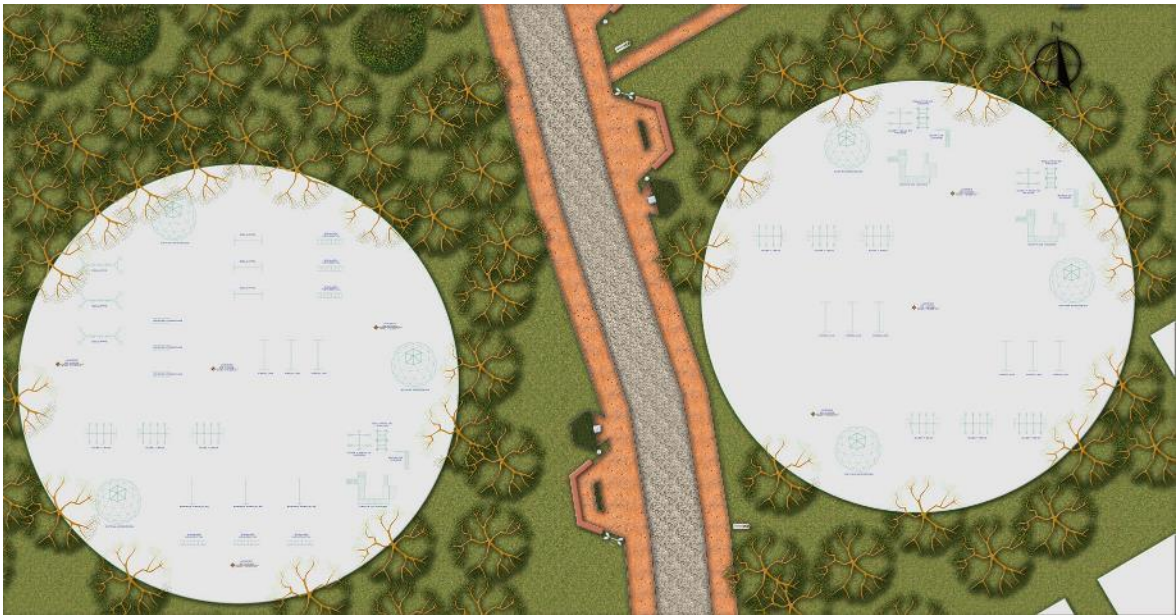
Planta de Centro Geriátrico Turístico
